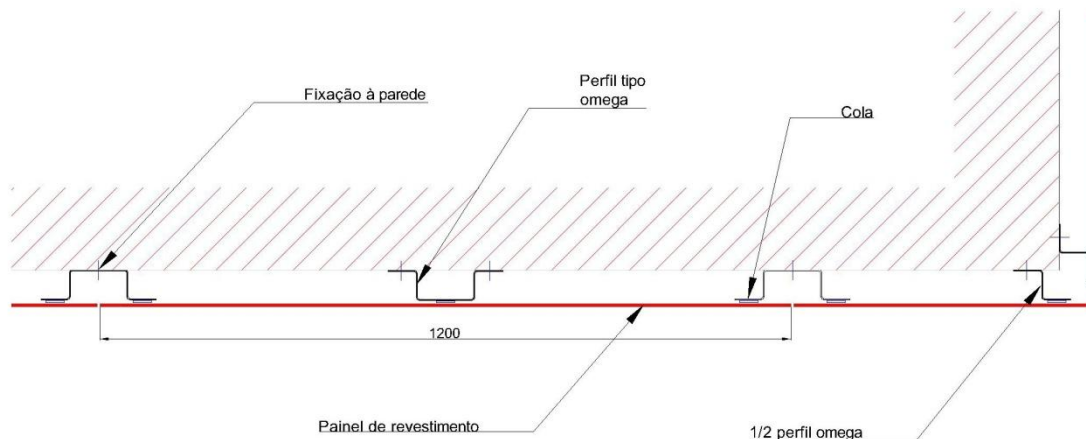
Esquemática de uma das possibilidades de fixação do painel cerâmico utilizando 3 apoios
